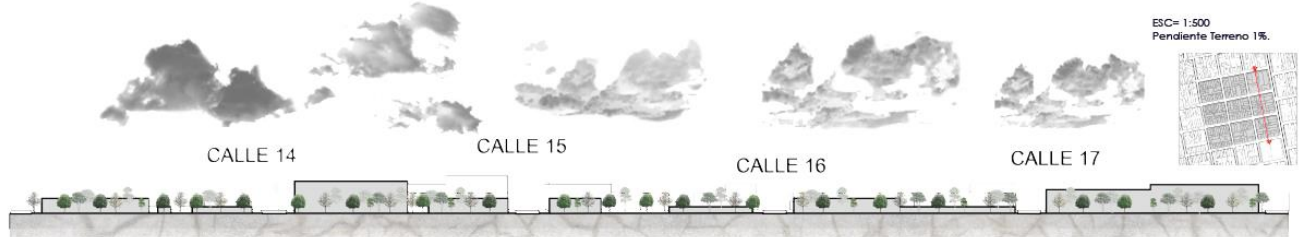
Sección transversal A de área de intervención. Fuente: elaboración propia.
